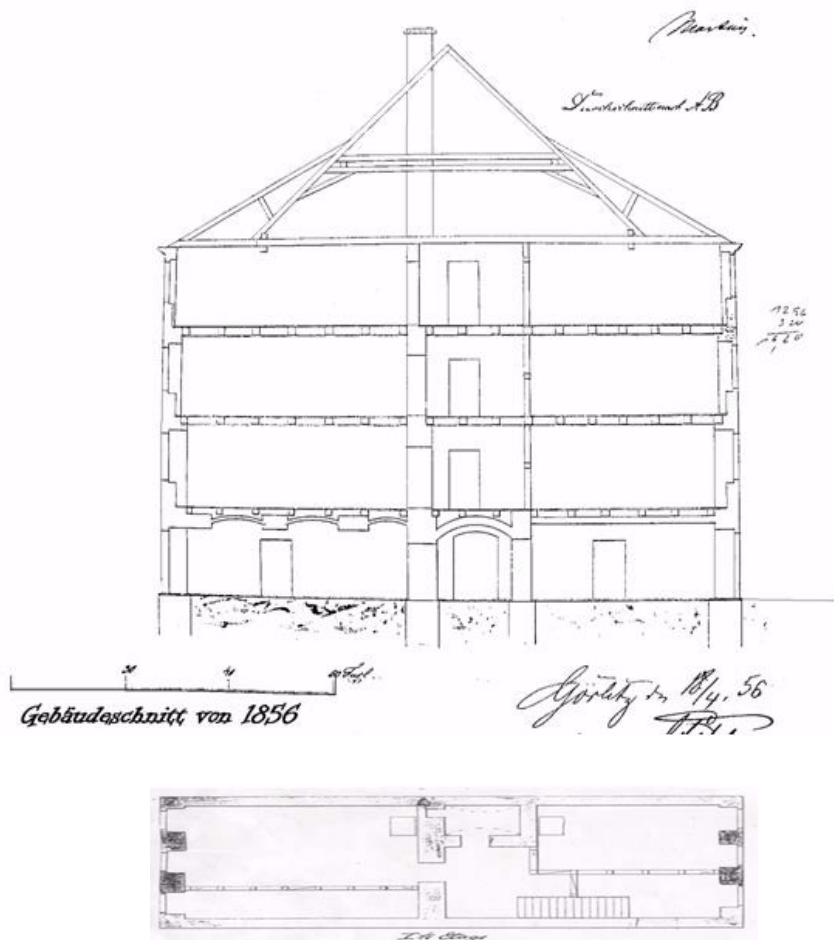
Gebäudeschnitt und Grundriss des 1. OG von 1856
